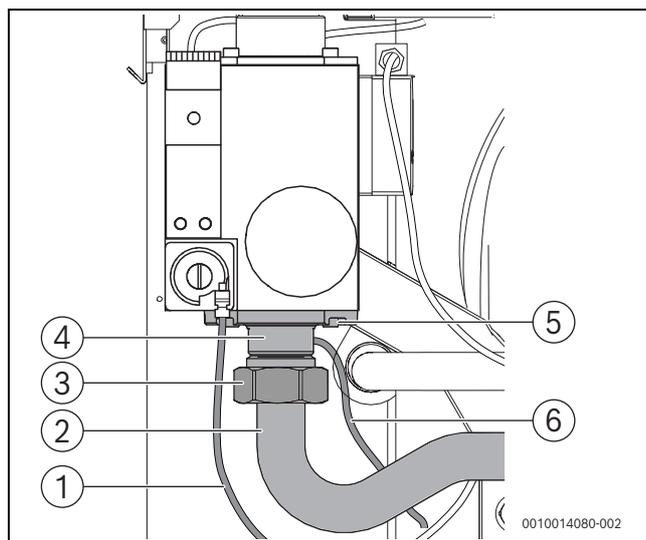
Smontaggio del diaframma del gas (caldaie di dimensione 150; 200 - 300 kW)
